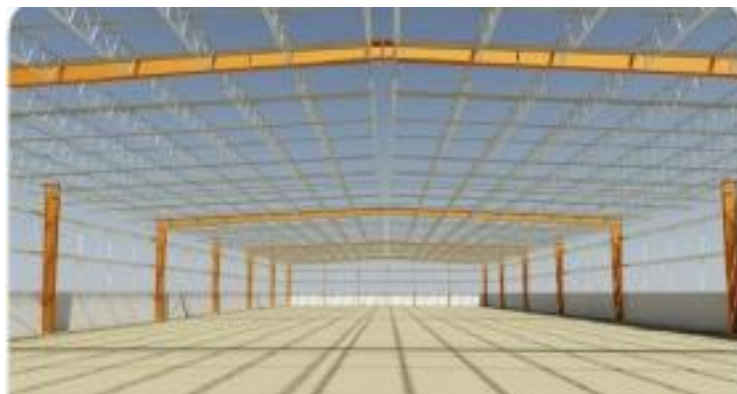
Exemplo de um pórtico de aço (arquivo da empresa Entermetal).
